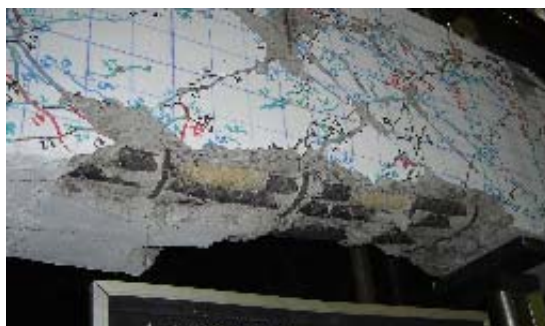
Detalle del daño lado izquierdo: desprendimiento de concreto y pérdida de adherencia
